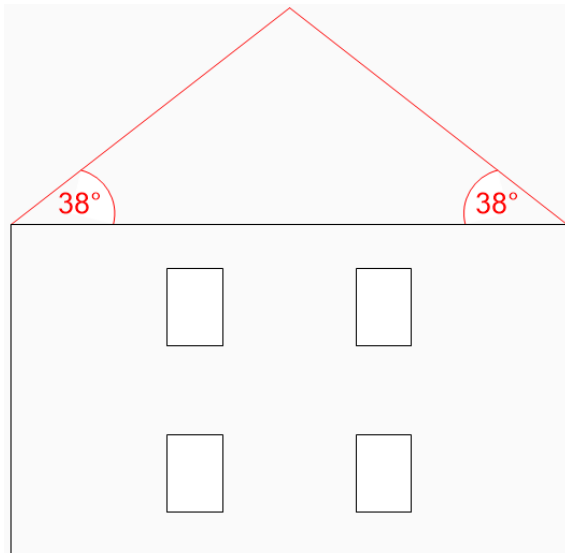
Beispiel für ein symmetrisches Dach, hier z.B. mit 38° Neigung, Ansicht von der Giebelseite
